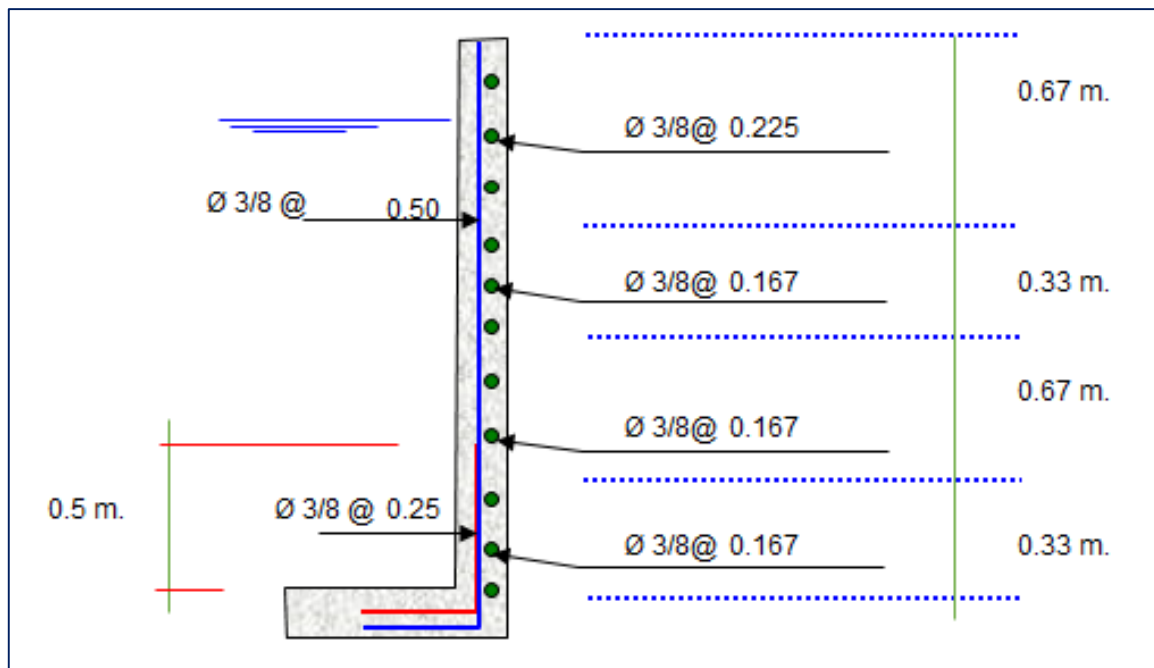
Detalle de la disposición final del acero en las paredes del reservorio.
